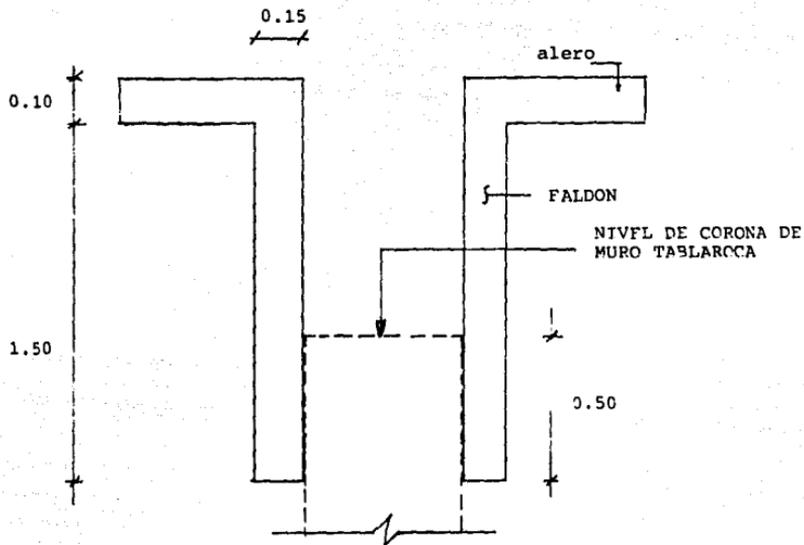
(BRCAL.. DIMENSIONES).
